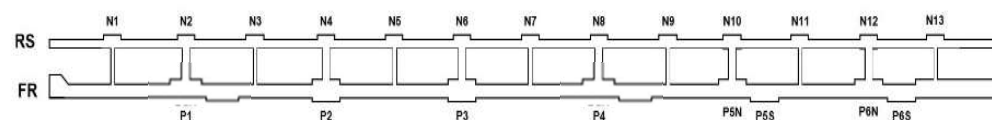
Tunnellayout, modifiziert – Variante 1
